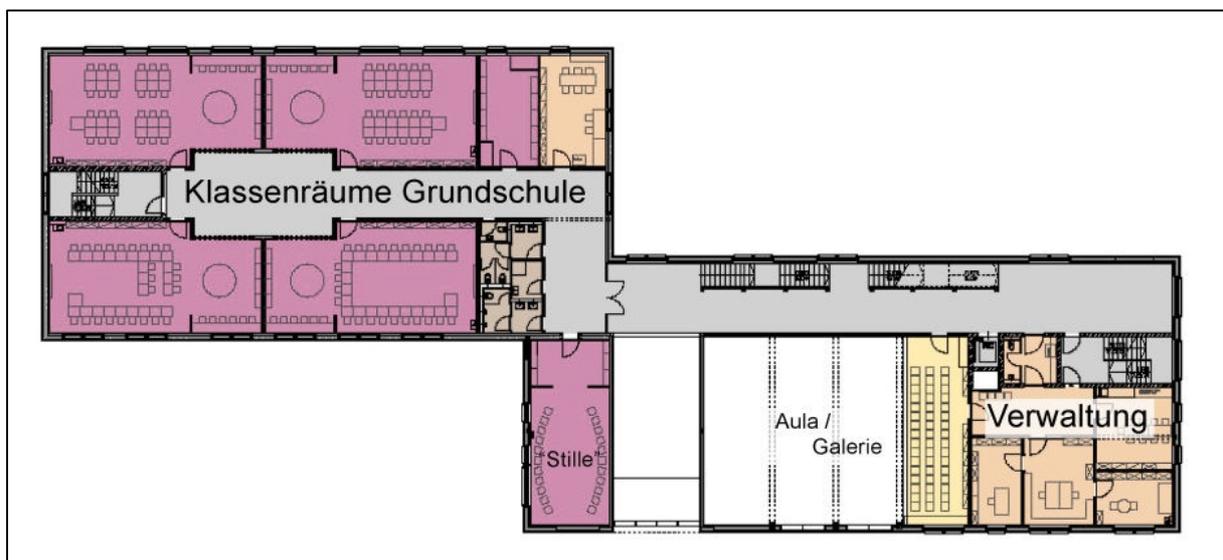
Grundriss 1. OG mit Nutzung
